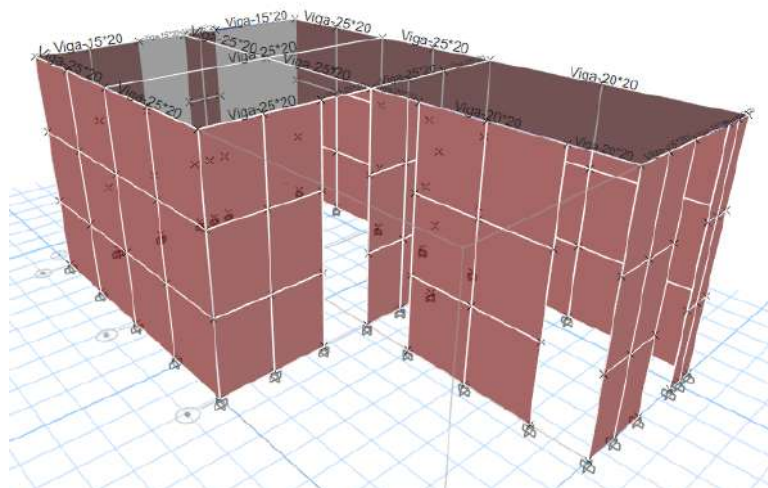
Vista en planta del modelamiento de la vivienda 12
